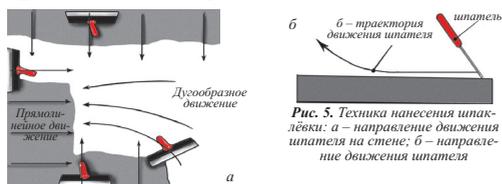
Техника нанесения шпаклёвки: а – направление движения шпателя на стене; б – направление движения шпателя
